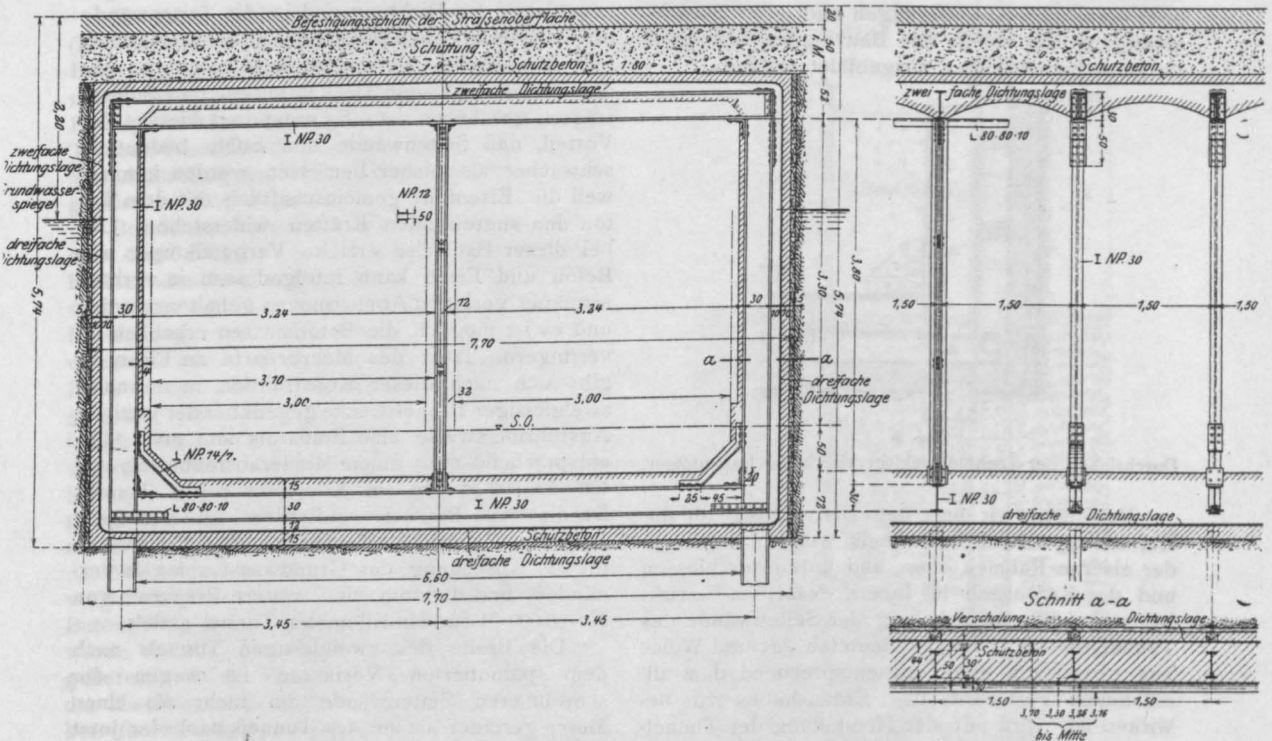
Untergrundbahntunnel nach dem patentierten Verfahren.
